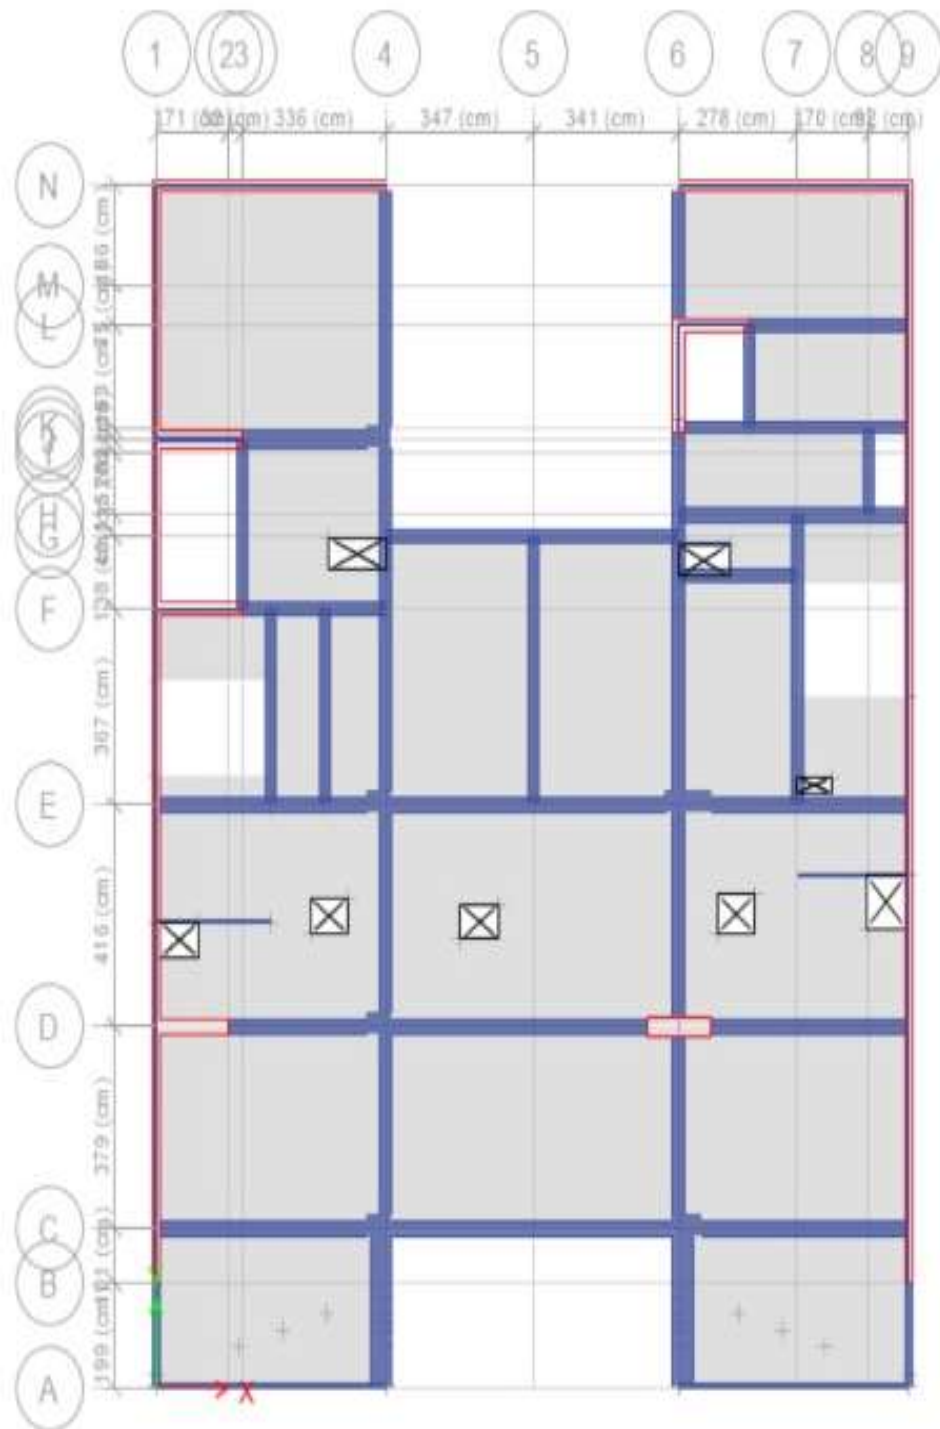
Edificio MG planta típica estructura modelada en Etabs
